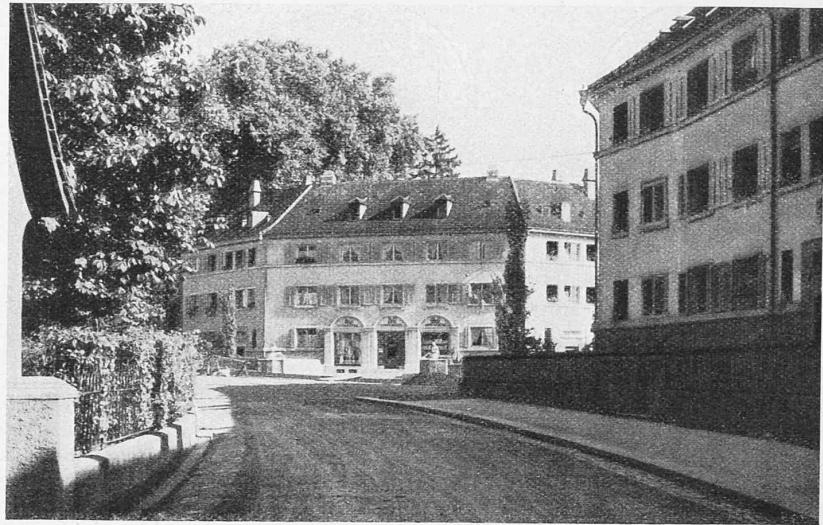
und 10. Frontansicht und Grundriss 1:400 des Doppelhauses VII/VIII an der Strassenkreuzung.
